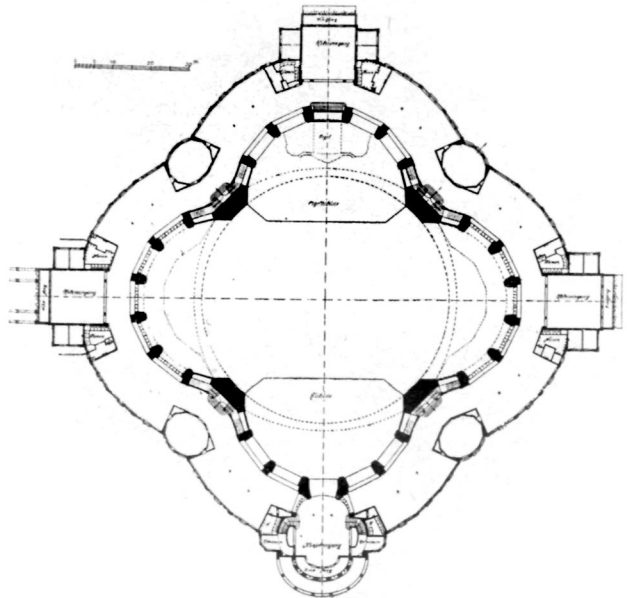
Jahrhunderthalle zu Breslau. Grundriß
